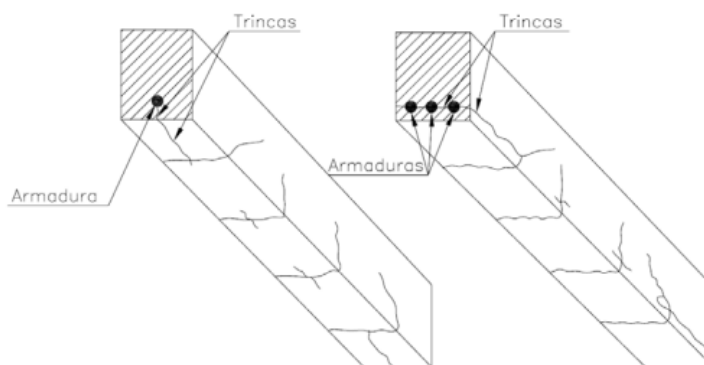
Trincas ou fissuras típicas provocadas por corrosão
